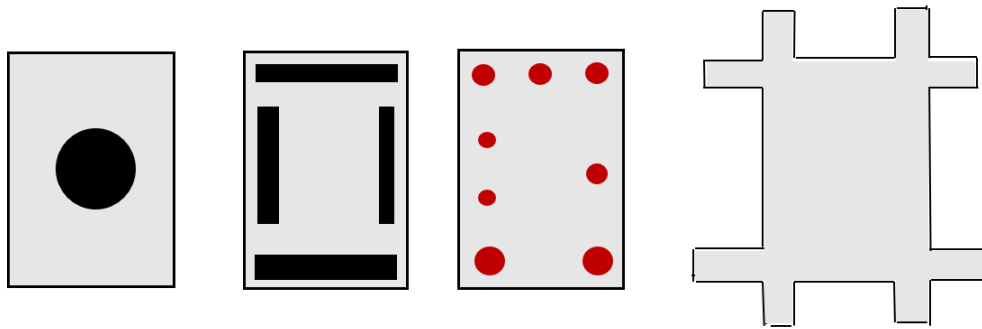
Secciones transformadas equivalentes de secciones de concreto reforzado.
